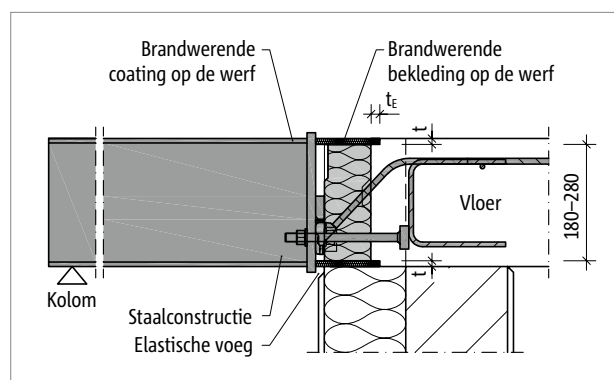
Schöck Isokorb® T type SK: Op de werf aangebrachte brandwerende bekleding voor Isokorb® en staalconstructie, doorsnede
